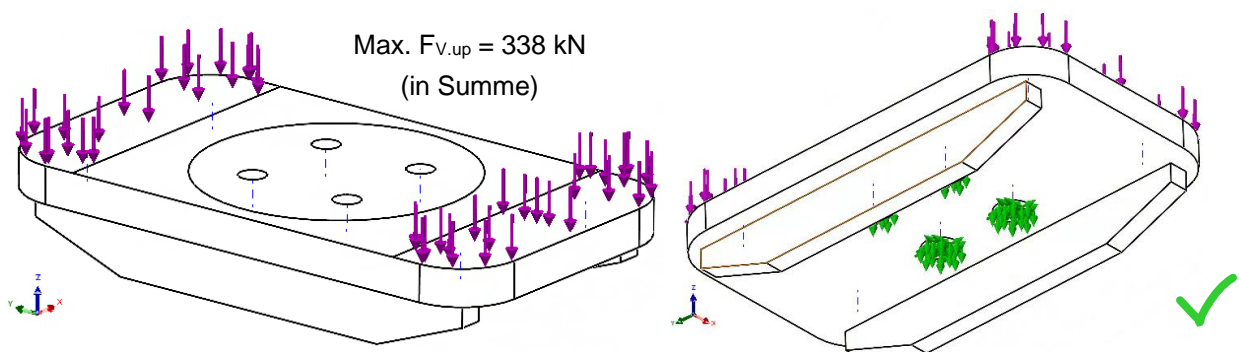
Geschraubte Sicherungsplatte B-L für alle Brücken außer Brücke B4 – Übersicht, Lagerung, Lasten
